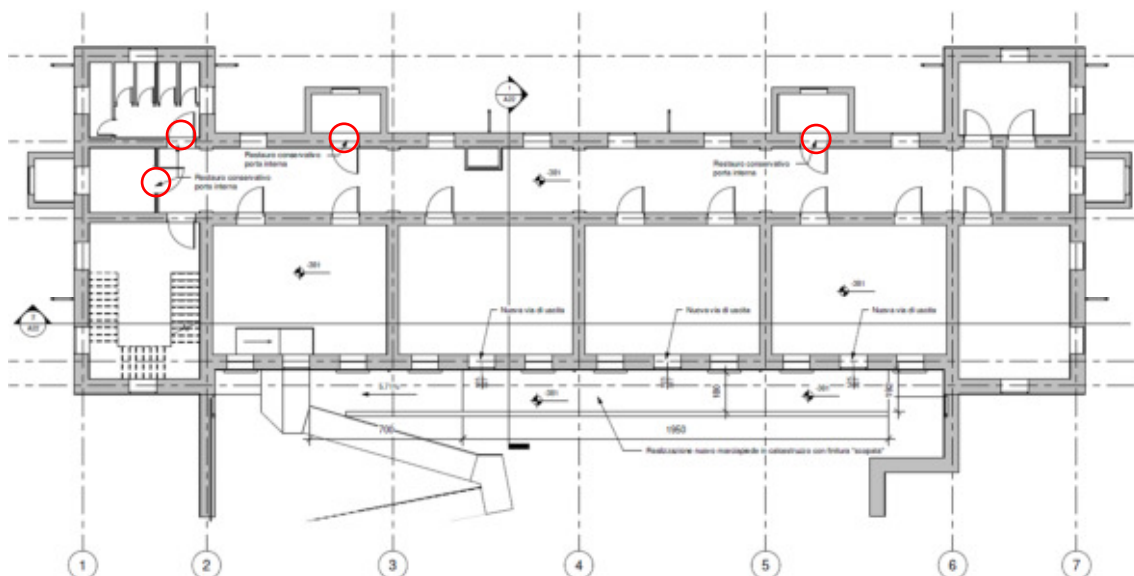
Pianta piano seminterrato – Indicazione porte da restaurare
